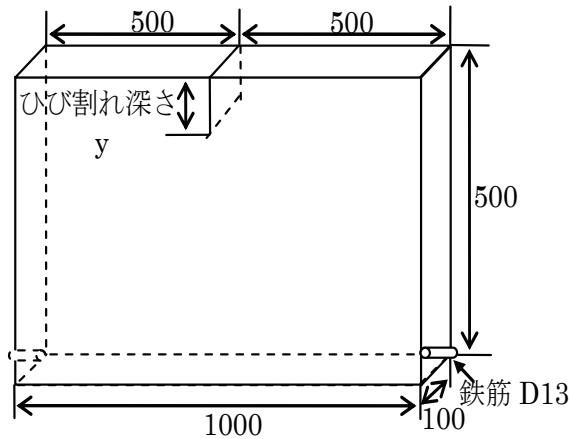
模擬ひび割れ深さ試験体（単位：mm）
